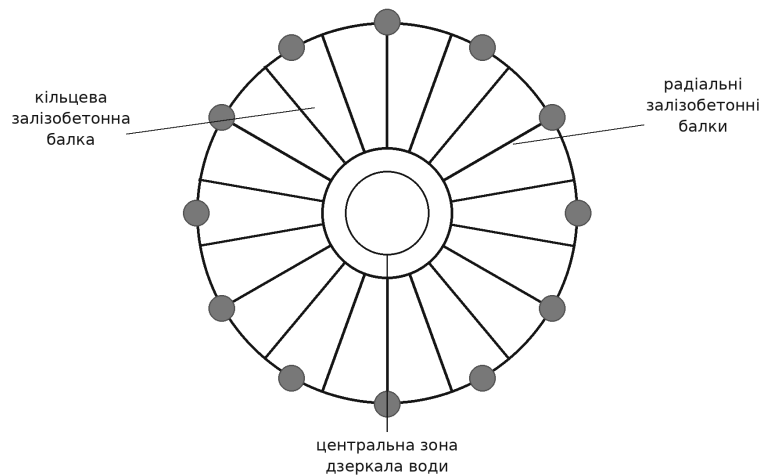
Принципова схема радіальних залізобетонних балок та кільцевої балки під дзеркалом води
